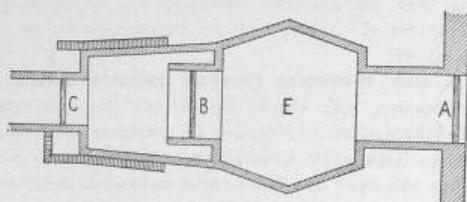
Grundriss vom Einlauf des Emissars des Fuciner-Sees. (Schematisch.)
